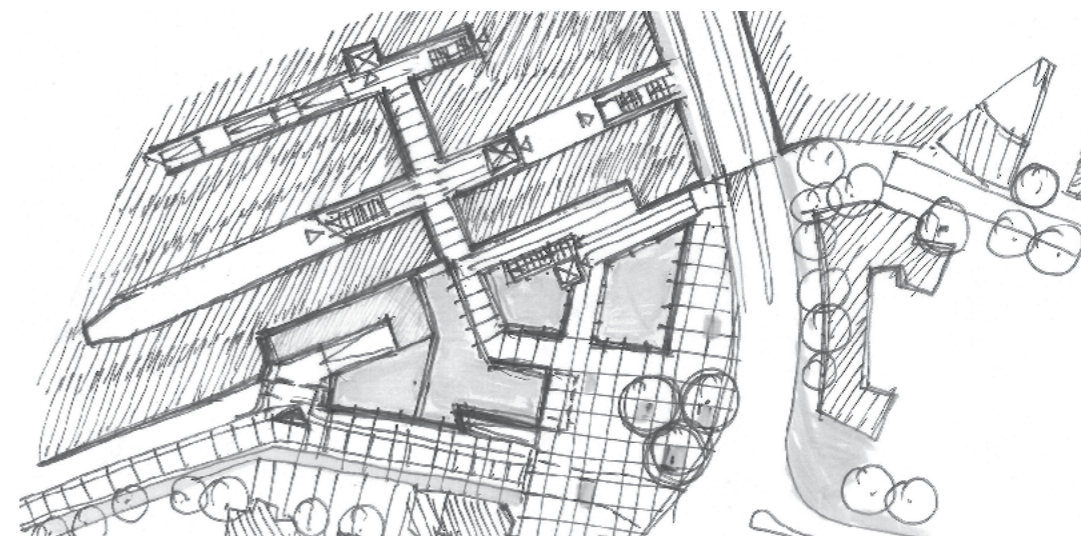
Propozycja kształtowania placu na zadaszniu budynku wielofunkcyjnego w wariantcie ekstensywnym
